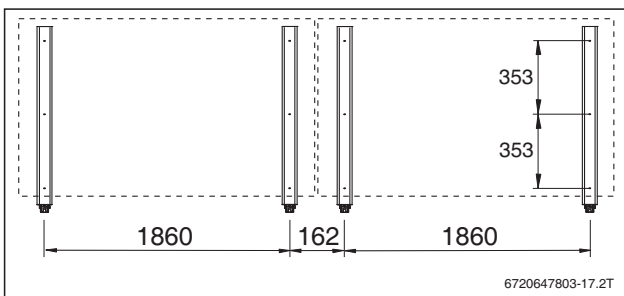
Abstände der Kollektorstützen bei Grundausführung von für 2 waagerechte SKN4.0-w (Maße in mm)
